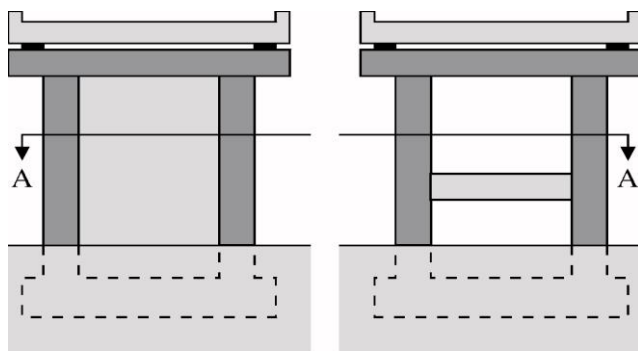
Tipo pilas con dos o más columnas con cabezal común
